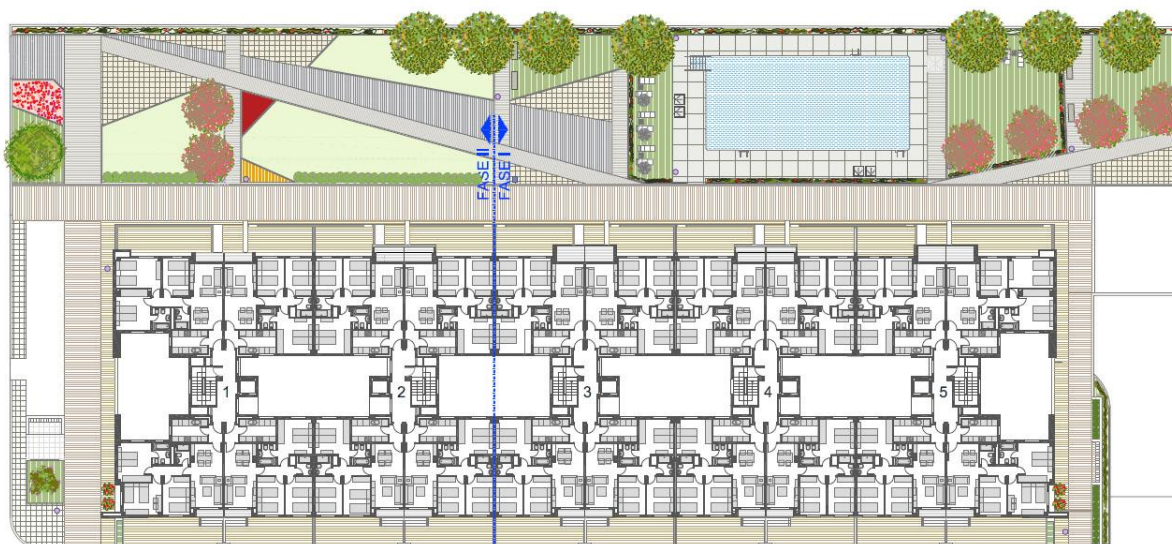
Edificio N°2. Planta Tipo. Fuente: <http://www.vimcorsa.com>
